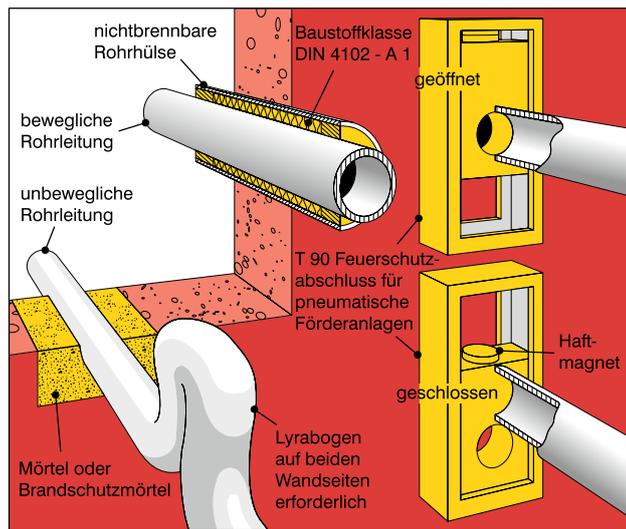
Wanddurchführung für nichtbrennbare Rohrleitungen (Ausschnitt)
